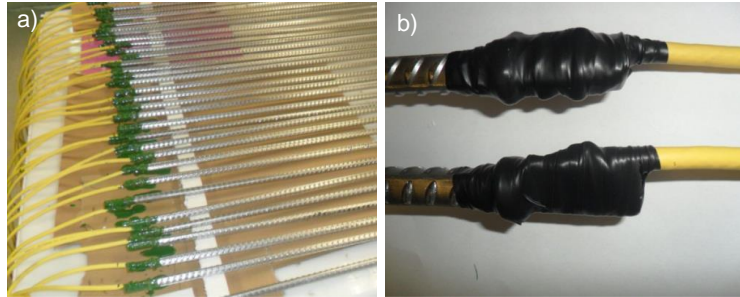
a) Zonas de intersección cable/barra pintadas con resina epoxi. b) Intersección encintada.
